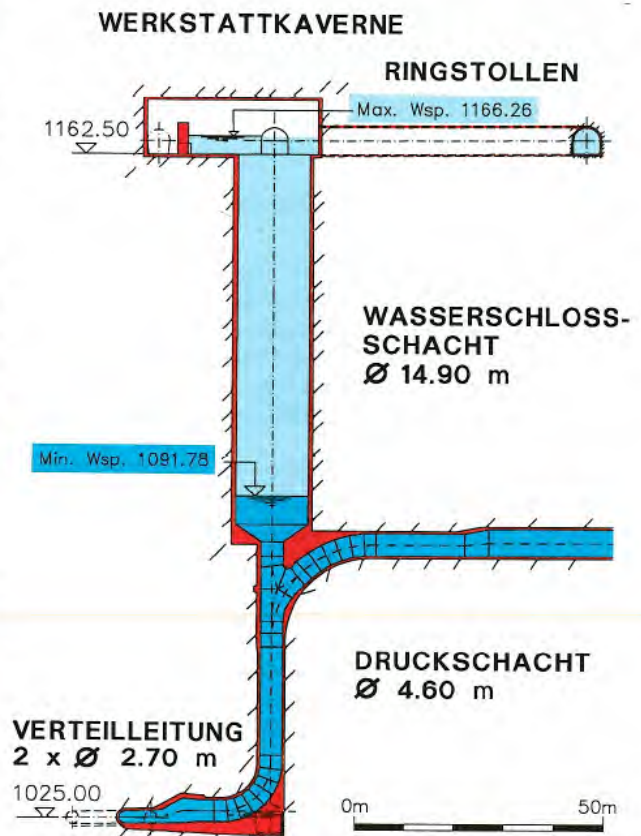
Längsschnitt durch das Wasserschloss. Das Wasserschloss besteht aus einem Vertikalschacht, einer ringförmigen Wasserschlosskammer und der Werkstattkaverne. Der Druckschacht ist vollständig mit Stahl gepanzert.
